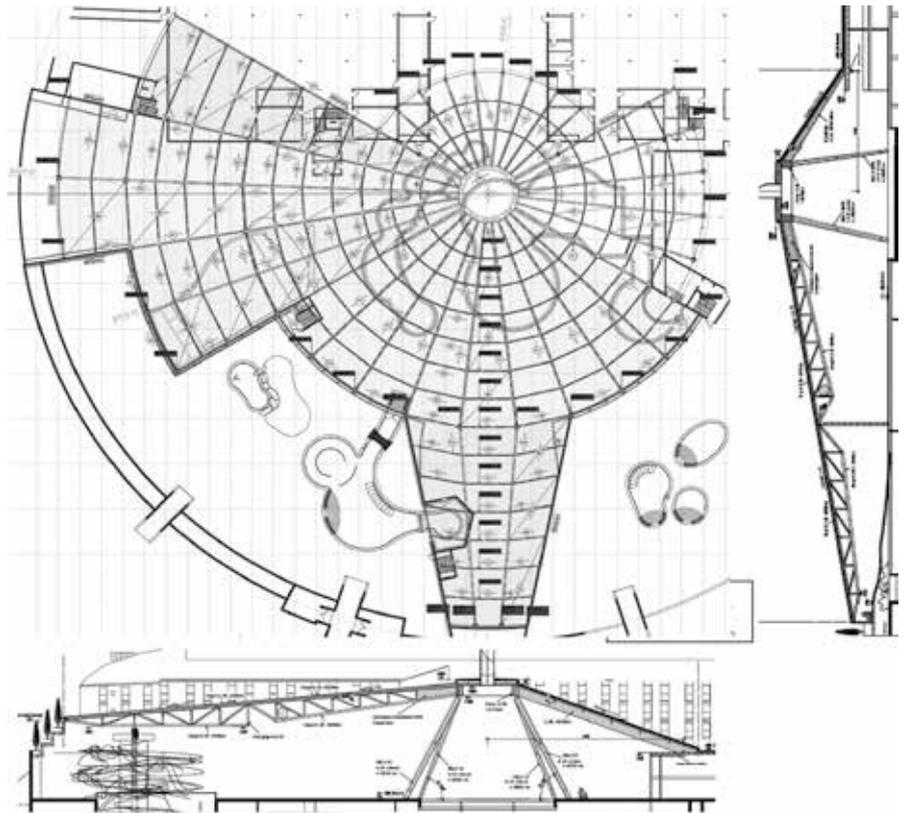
Grundriss, Schnitt A1 (vertikal) und Schnitt A2 (horizontal)
